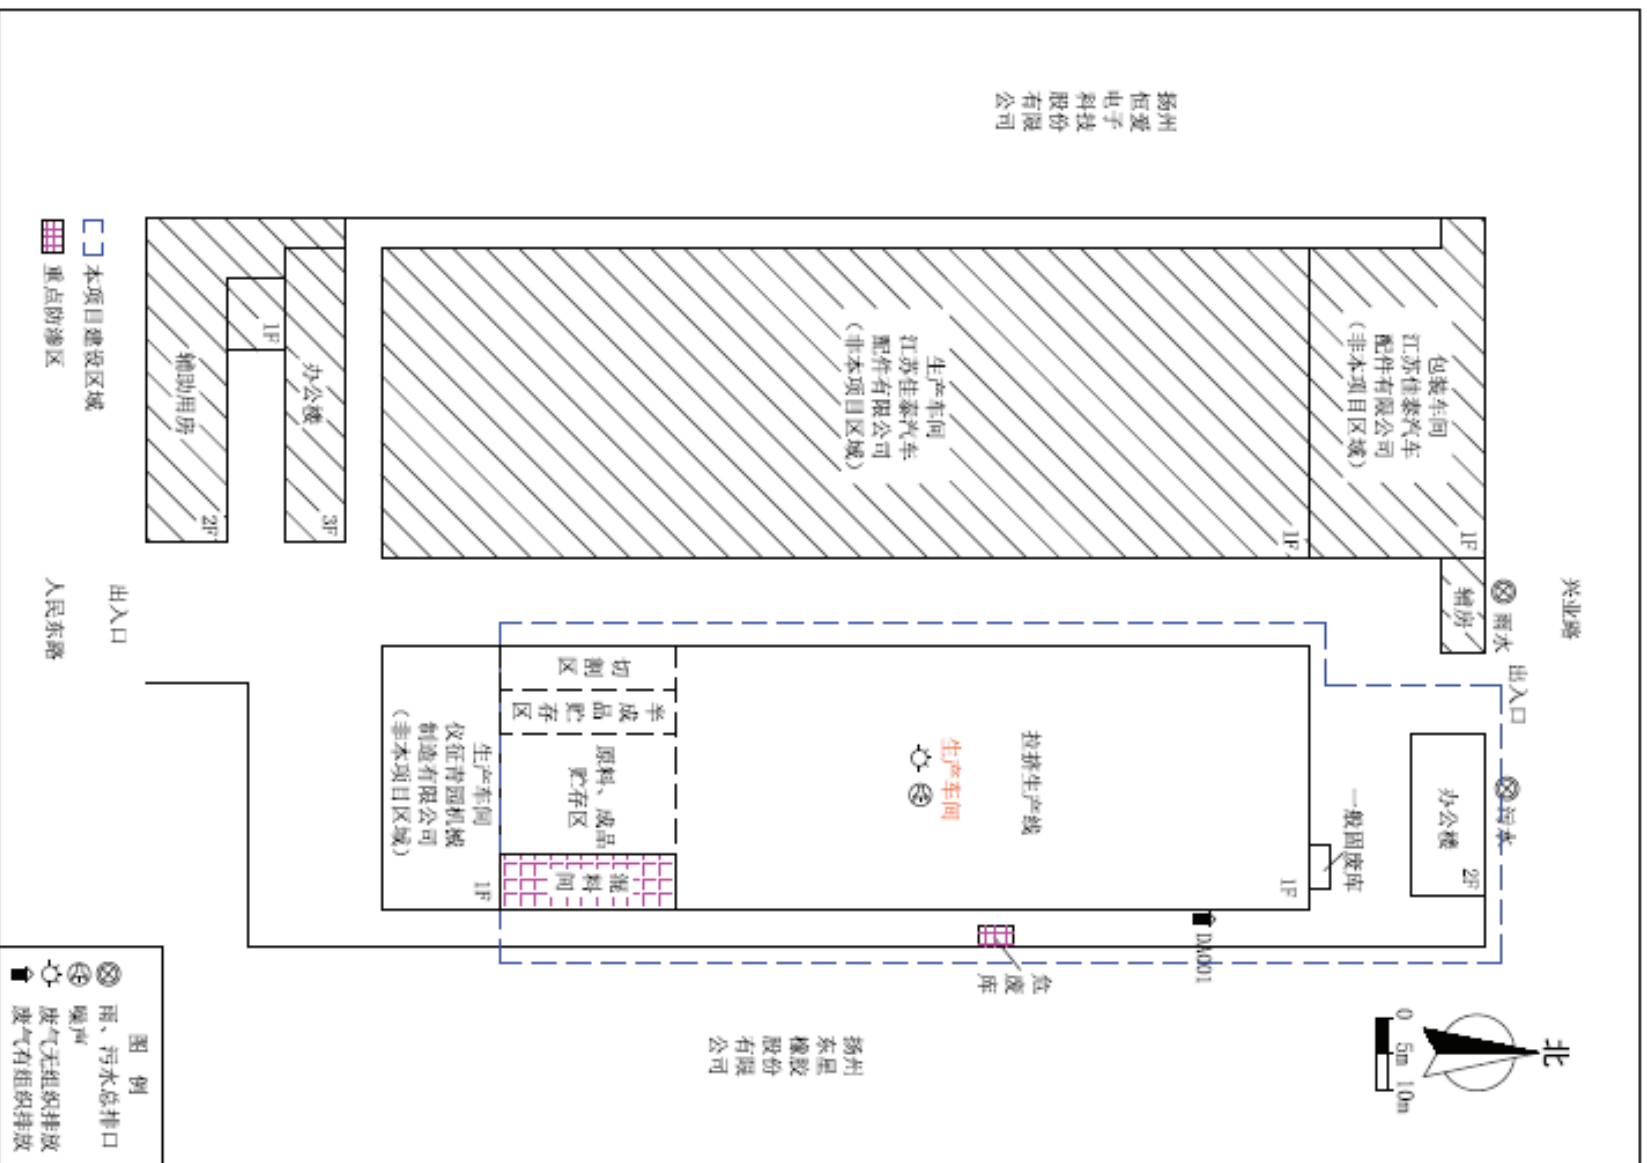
建设项目厂区总平面布置图 (环评中图)
